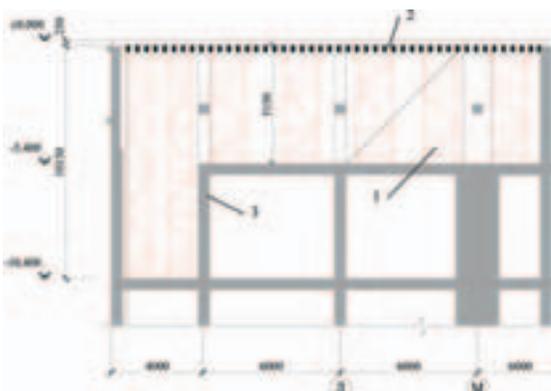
Схема опалубки монолитного перекрытия на отм. ±0,000:
